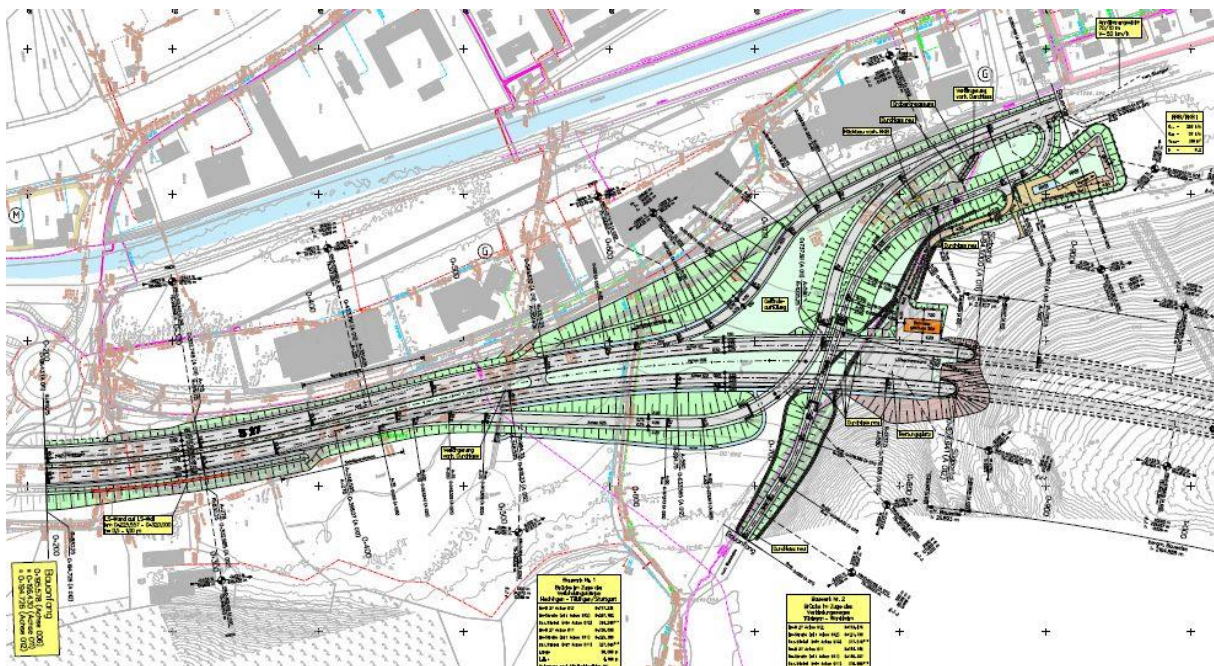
Lageplan Bläsibad – Halbanschluss mit zwei Brücken
